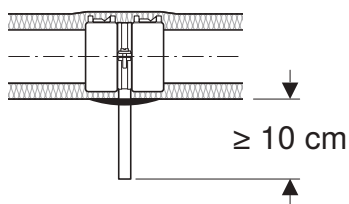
Fixpunkt för betongingjutna, isolerade Geberit utloppsrör
